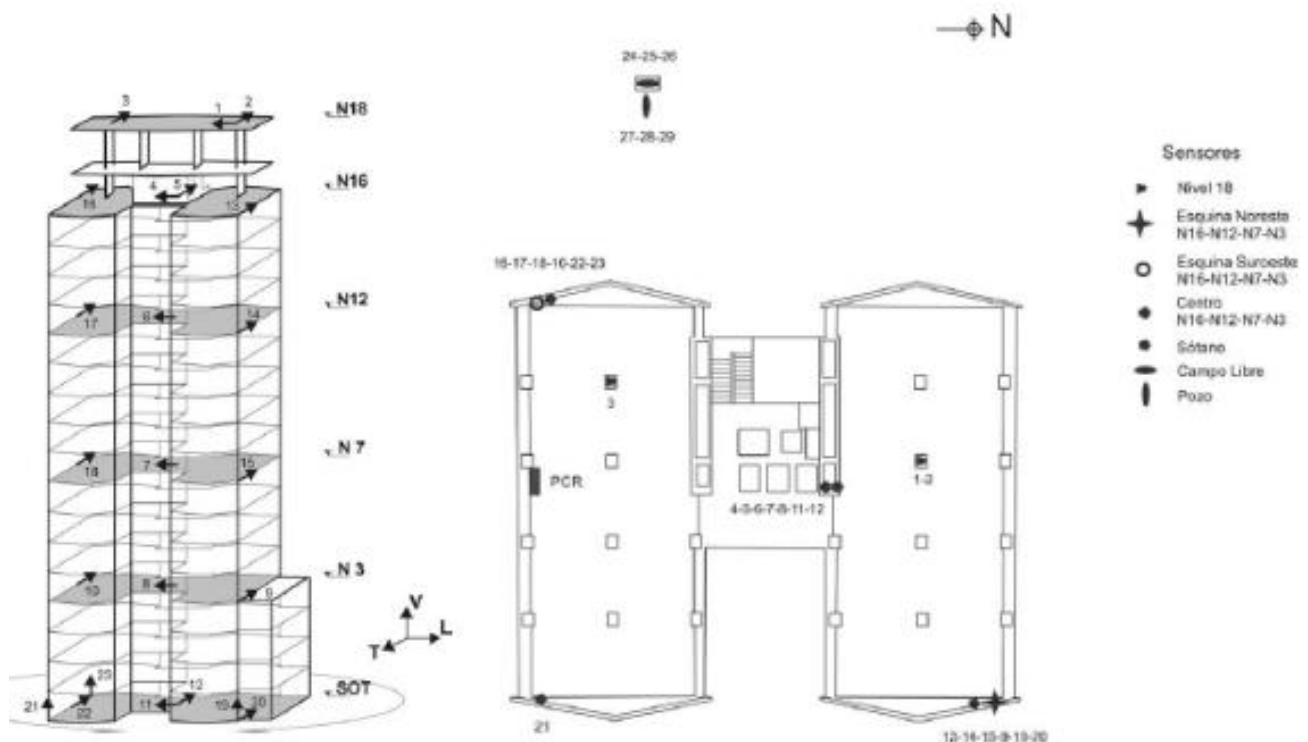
Ubicación de los sensores y vista en planta. Tomado de (Alcántara et al., 2004).
